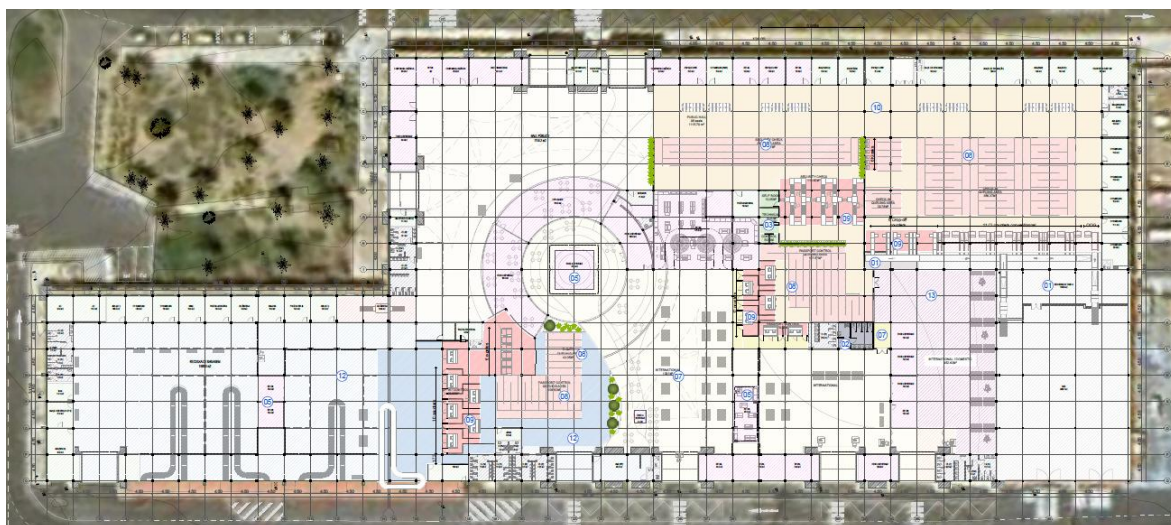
| Plano Funcional BVC Proposto - Fase 1B
